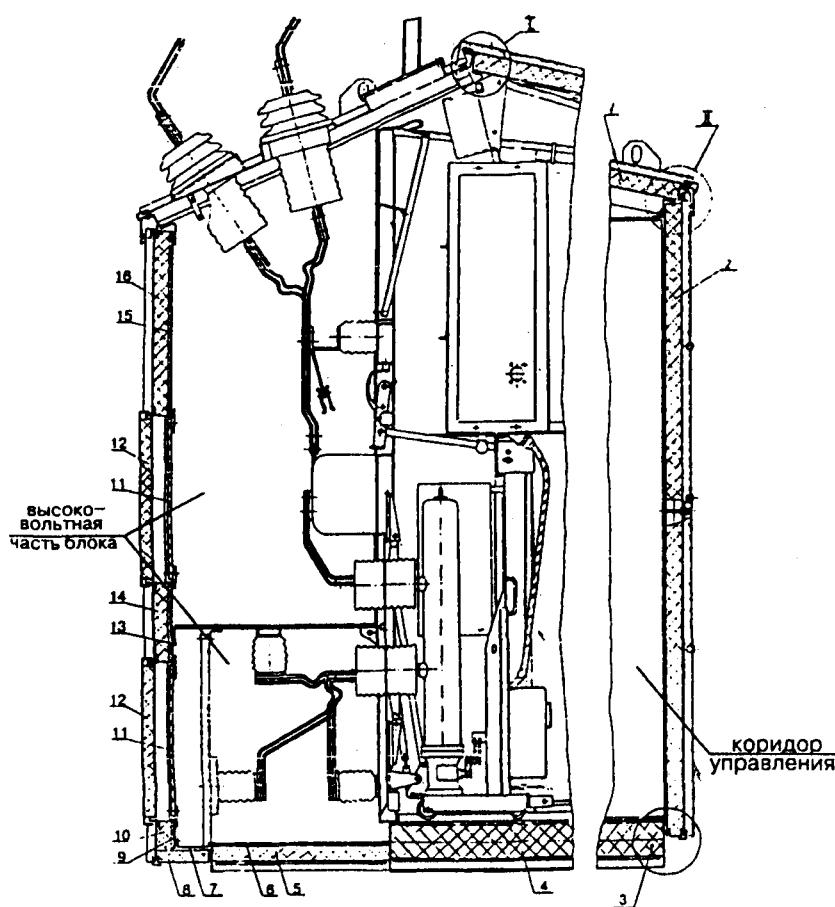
Вариант установки КРУ на заглубленном фундаменте
